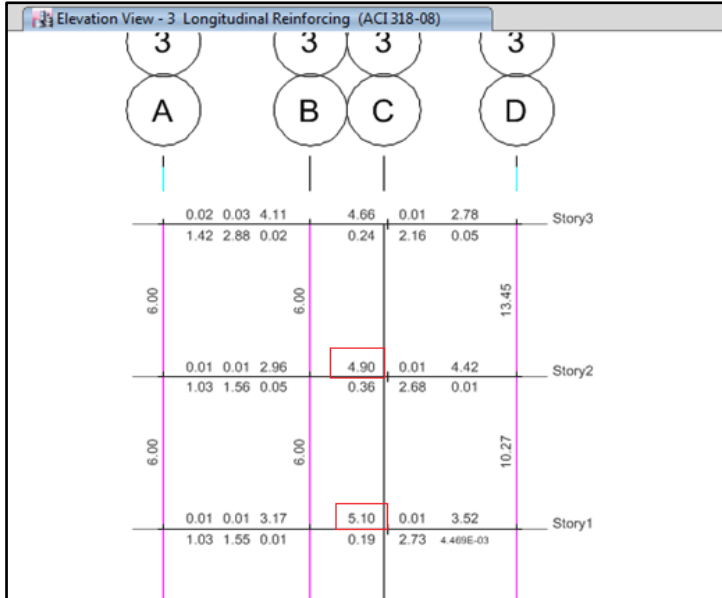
Acero que requiere las vigas del eje 2-2 entre A y D
